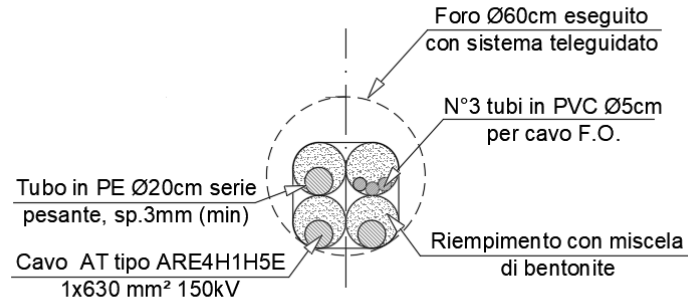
Sezione tipica di cavidotto posato con teleguidato
